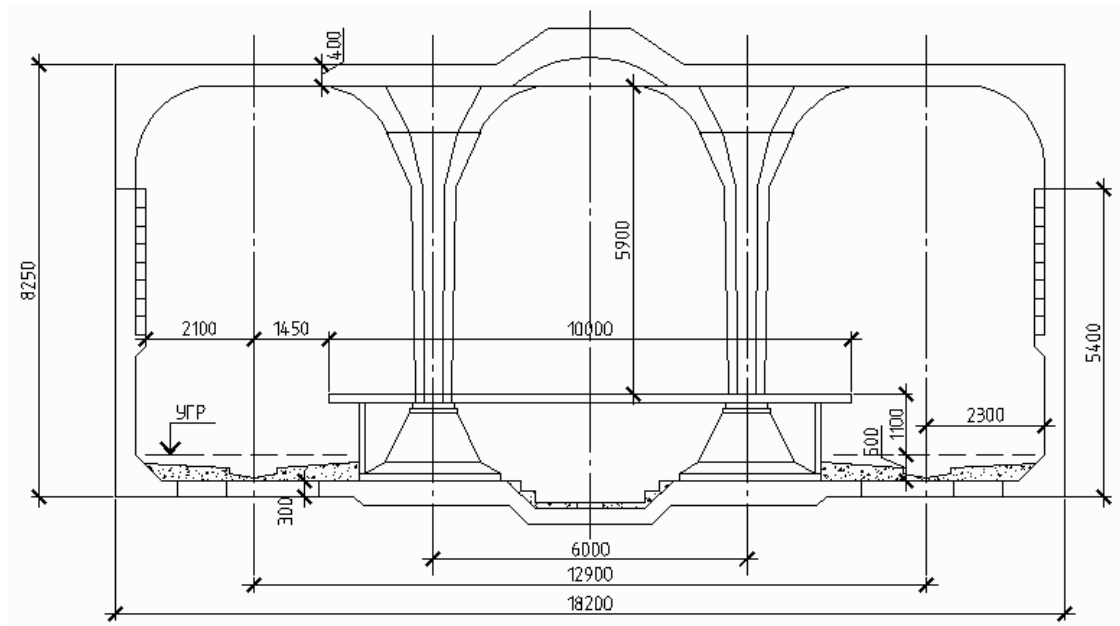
Конструктивна схема збірно-монолітної колонної станції з безбалочним перекриттям
